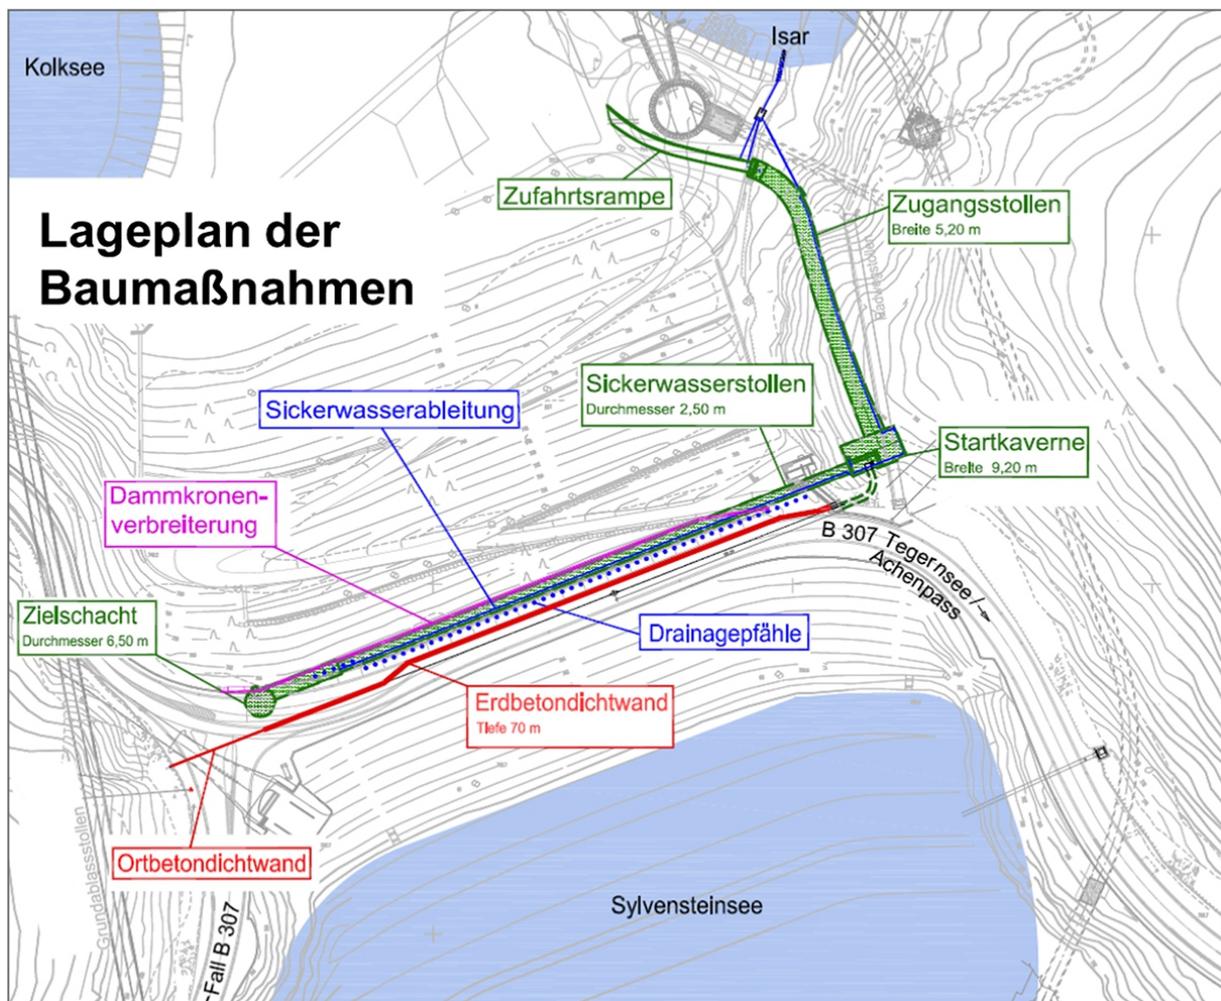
Lageplan zu den Ertüchtigungsmaßnahmen am Sylvensteinspeicher (Dichtwand, Sickerwasserstollen/Kontrollgang, Drainagepfähle)
